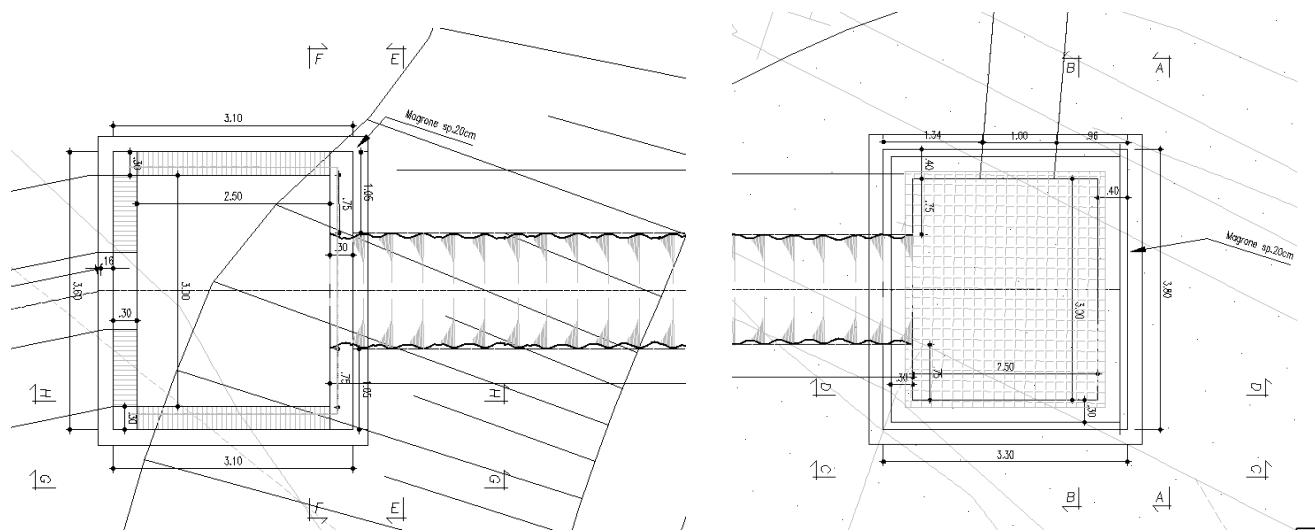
Pianta del Pozzetto di imbocco (a destra) e del Pozzetto di sbocco (a sinistra)
